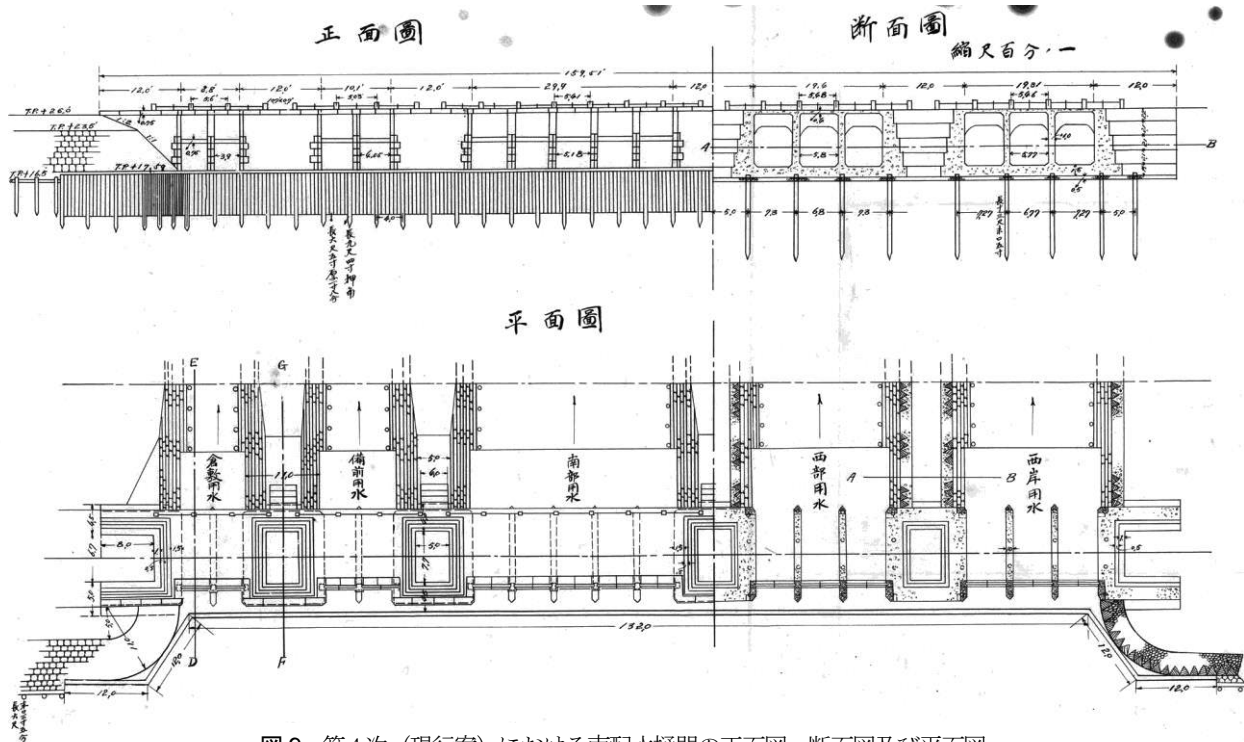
第4次（現行案）における南配水樋門の正面図，断面図及び平面図
